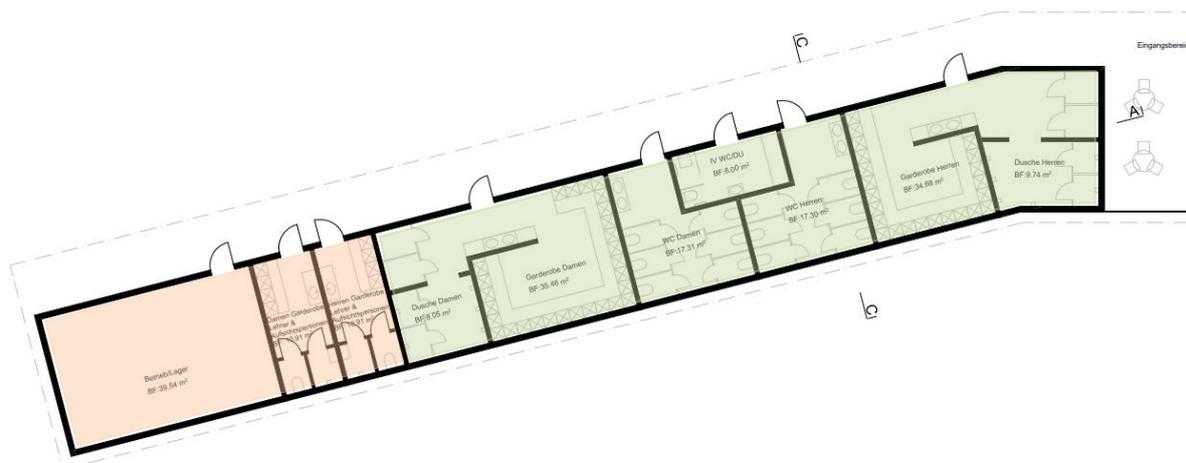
Grundriss mit öffentlicher (grüner Bereich) und betrieblicher (roter Bereich) Nutzung
